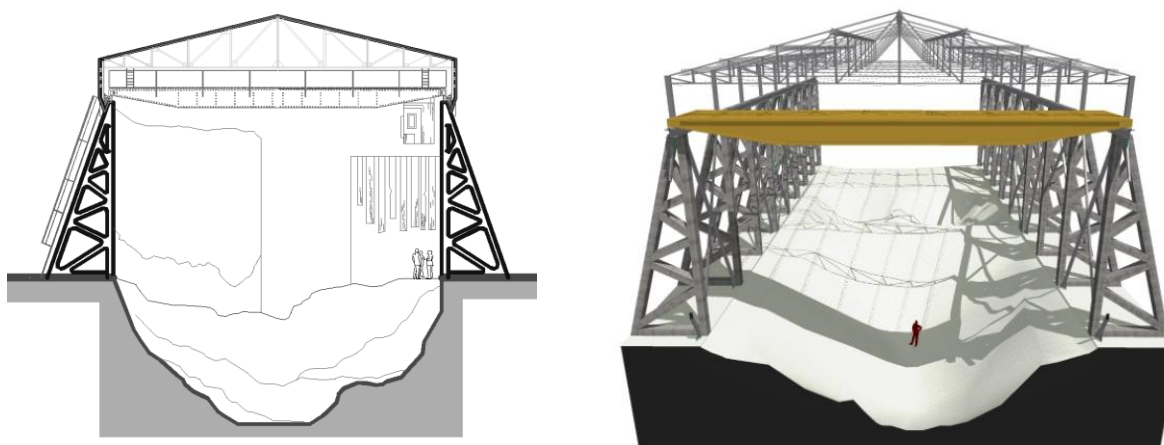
y 69. Corte transversal en plano y 3D, donde se puede observar el sistema constructivo de los marcos, además del riel que guía a la grúa viajera de 50 Ton. A lo largo de la nave industrial
